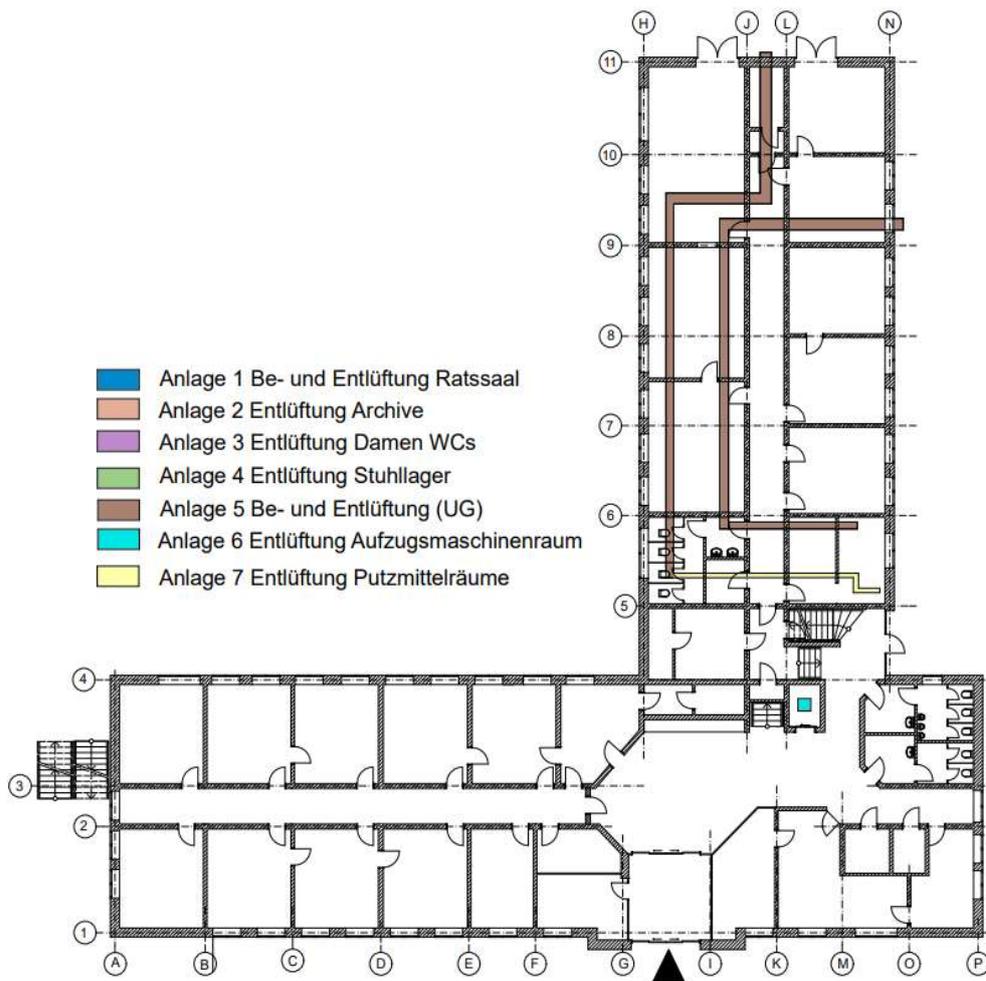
Lüftungsanlagen Erd- und Untergeschoss ohne Maßstab
